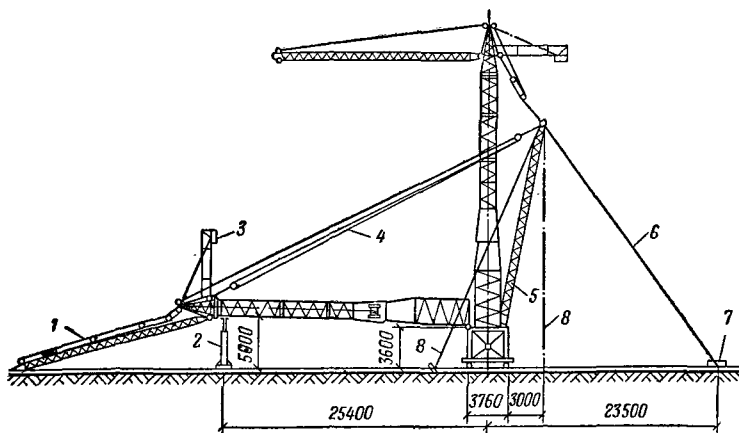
Схема монтажа башенного крана с помощью монтажной стрелы
